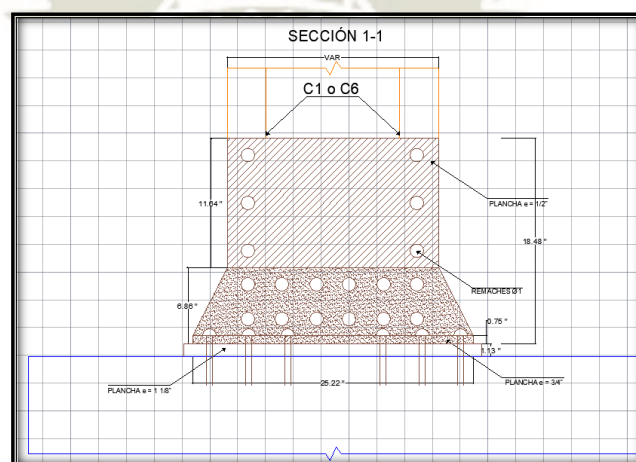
Elevaciones laterales de detalle de conexión de placa base
